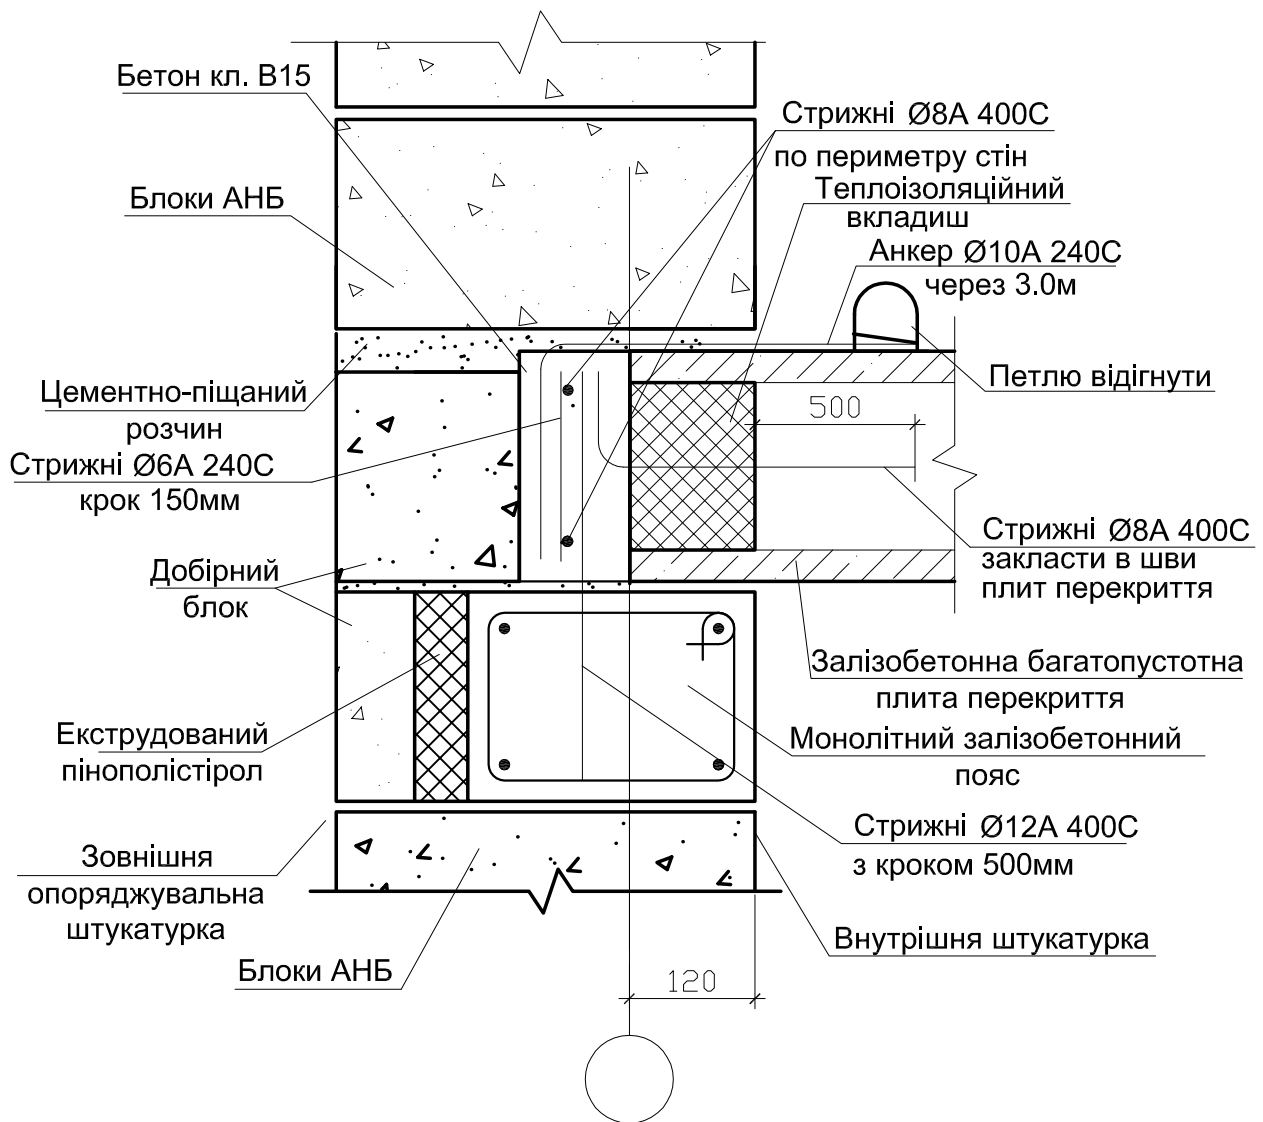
Спирання збірного залізобетонного перекриття на монолітний пояс
